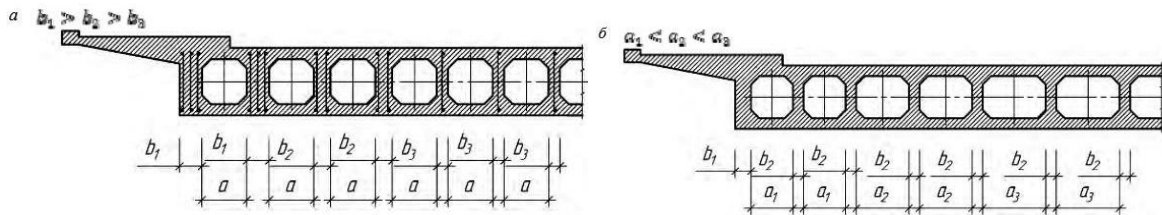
Поперечні перерізи зі зміною товщиною поздовжніх балок (а) або шириною вкладок (б) [26]
